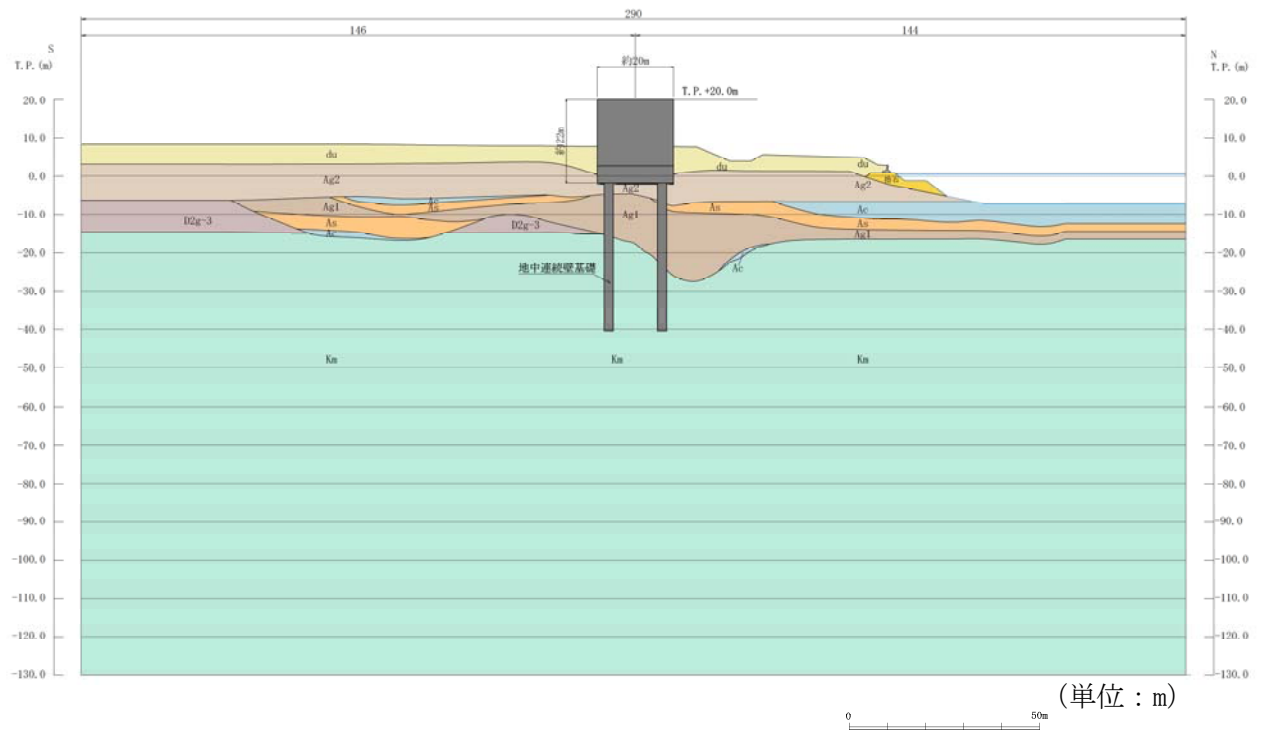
(2) 鉄筋コンクリート防潮壁 断面図(B-B断面)
